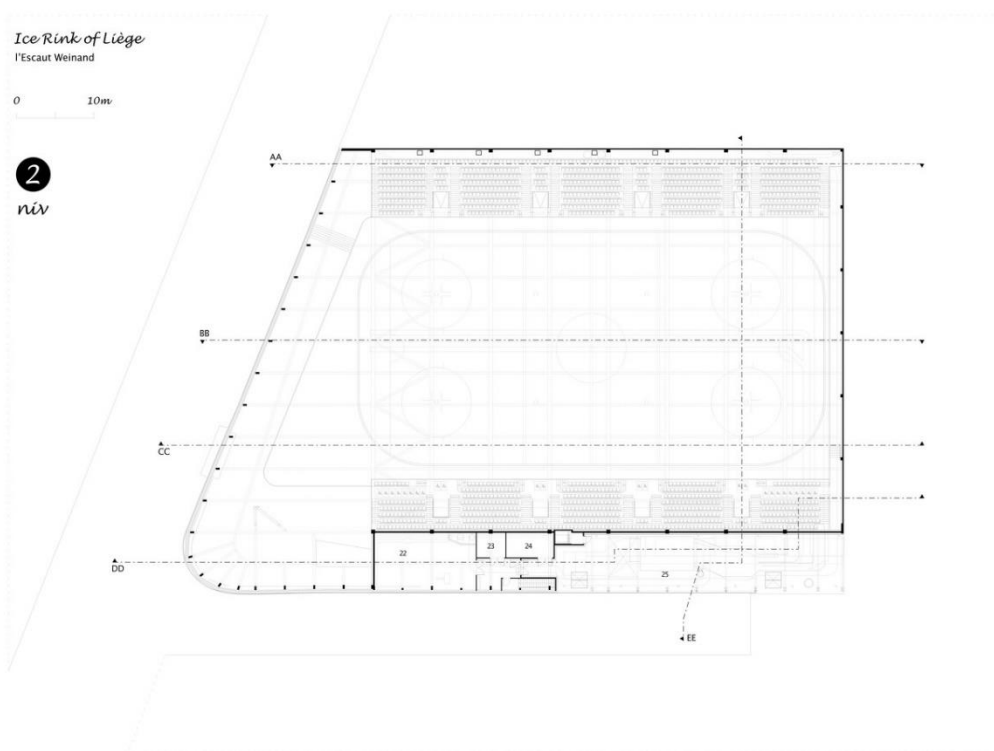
План другого поверху, арх. L'Escout Architectures + BE Weinand [5]
